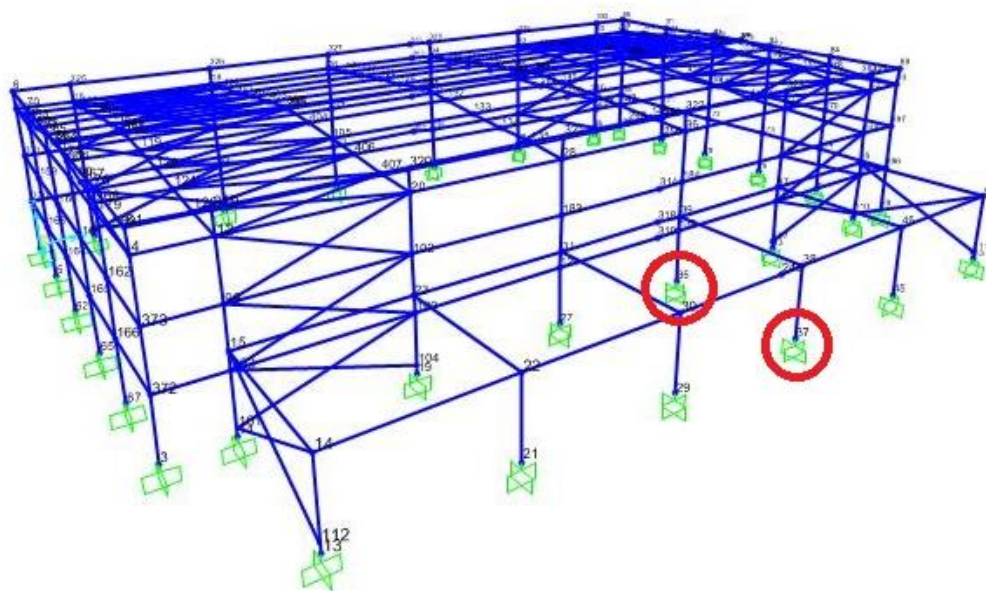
Situación de soportes para cálculo de las zapatas del pilar izquierdo y del pilar de vestuarios
